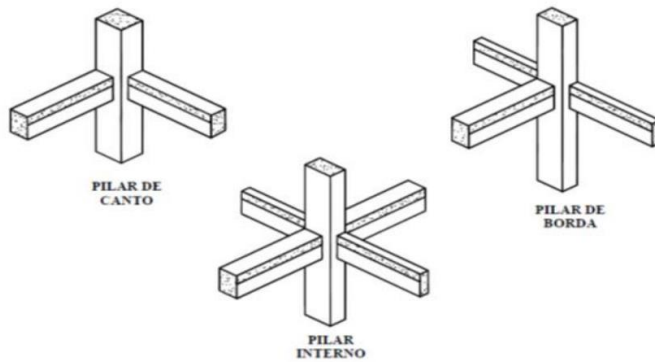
Tipos de encontros entre vigas e pilares (Fonte: Scandelai 2004)
